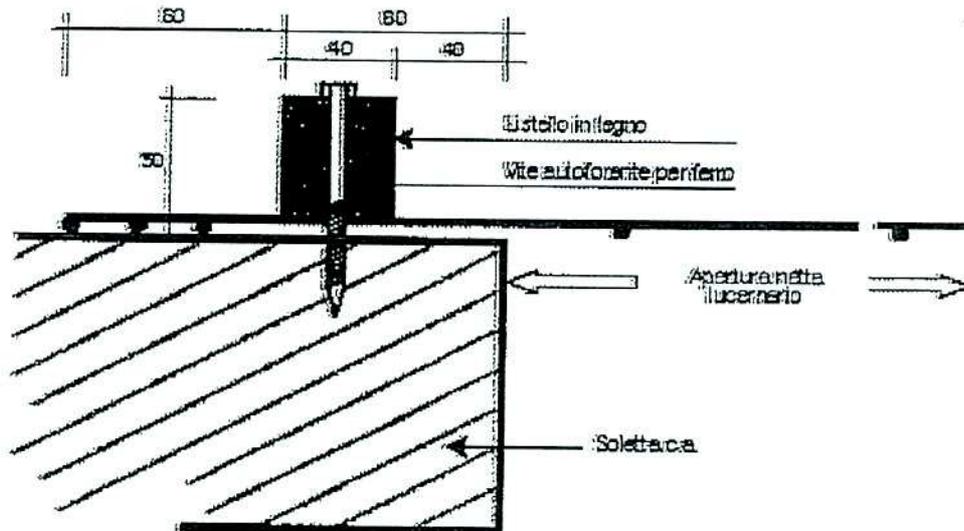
Sezione trasversale specifica di fissaggio rete posta sotto listello in legno (misure in mm)
